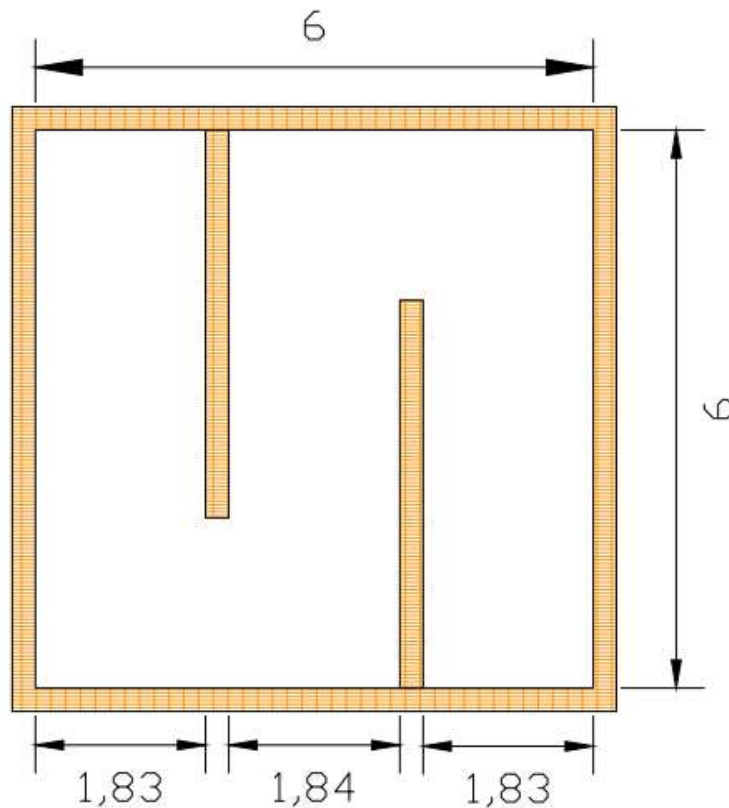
Propuesta tanque de contacto vista planta. Fuente: Autor
